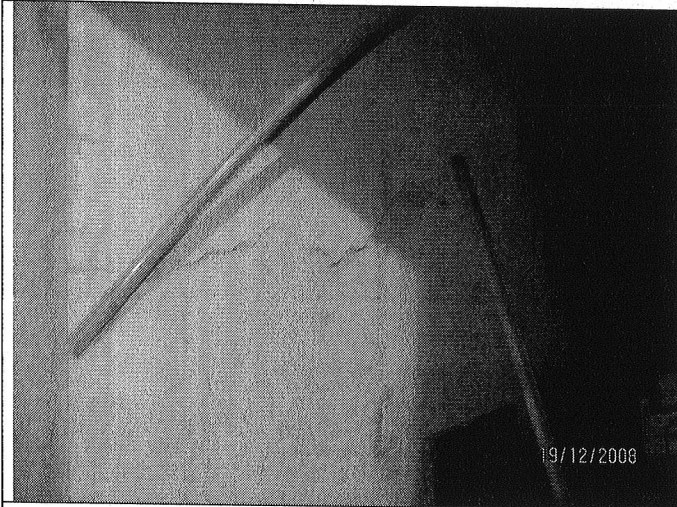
Fisura en muro divisorio de aproximadamente 2cm de ancho, localizada en el lote 15 de la manzana 18 del sector (De acuerdo a la Figura 1)
